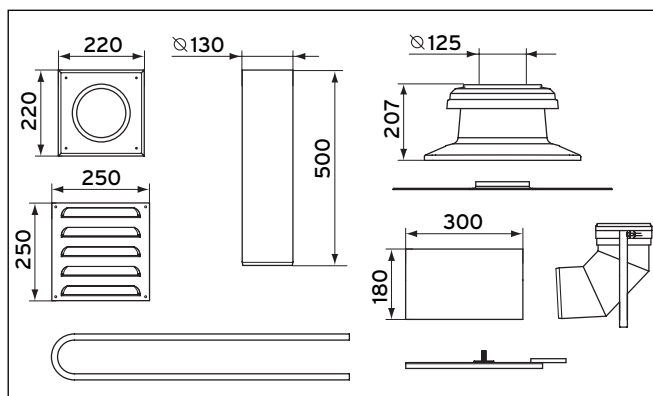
Lieferumfang Grundset für den Schachteinbau
